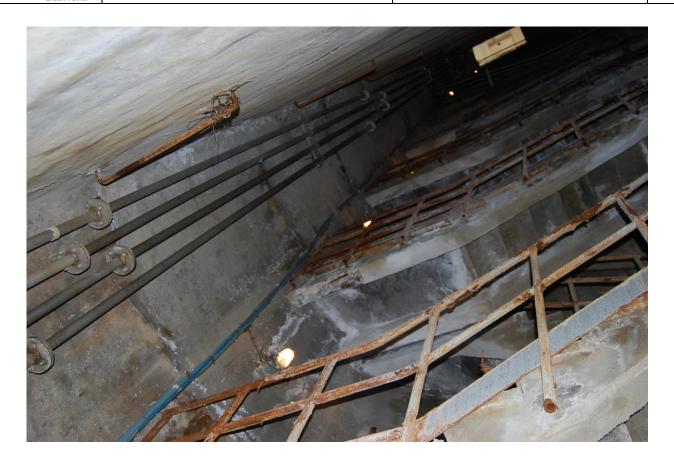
Pozzo di accesso alle camere di manovra - vista dal basso
